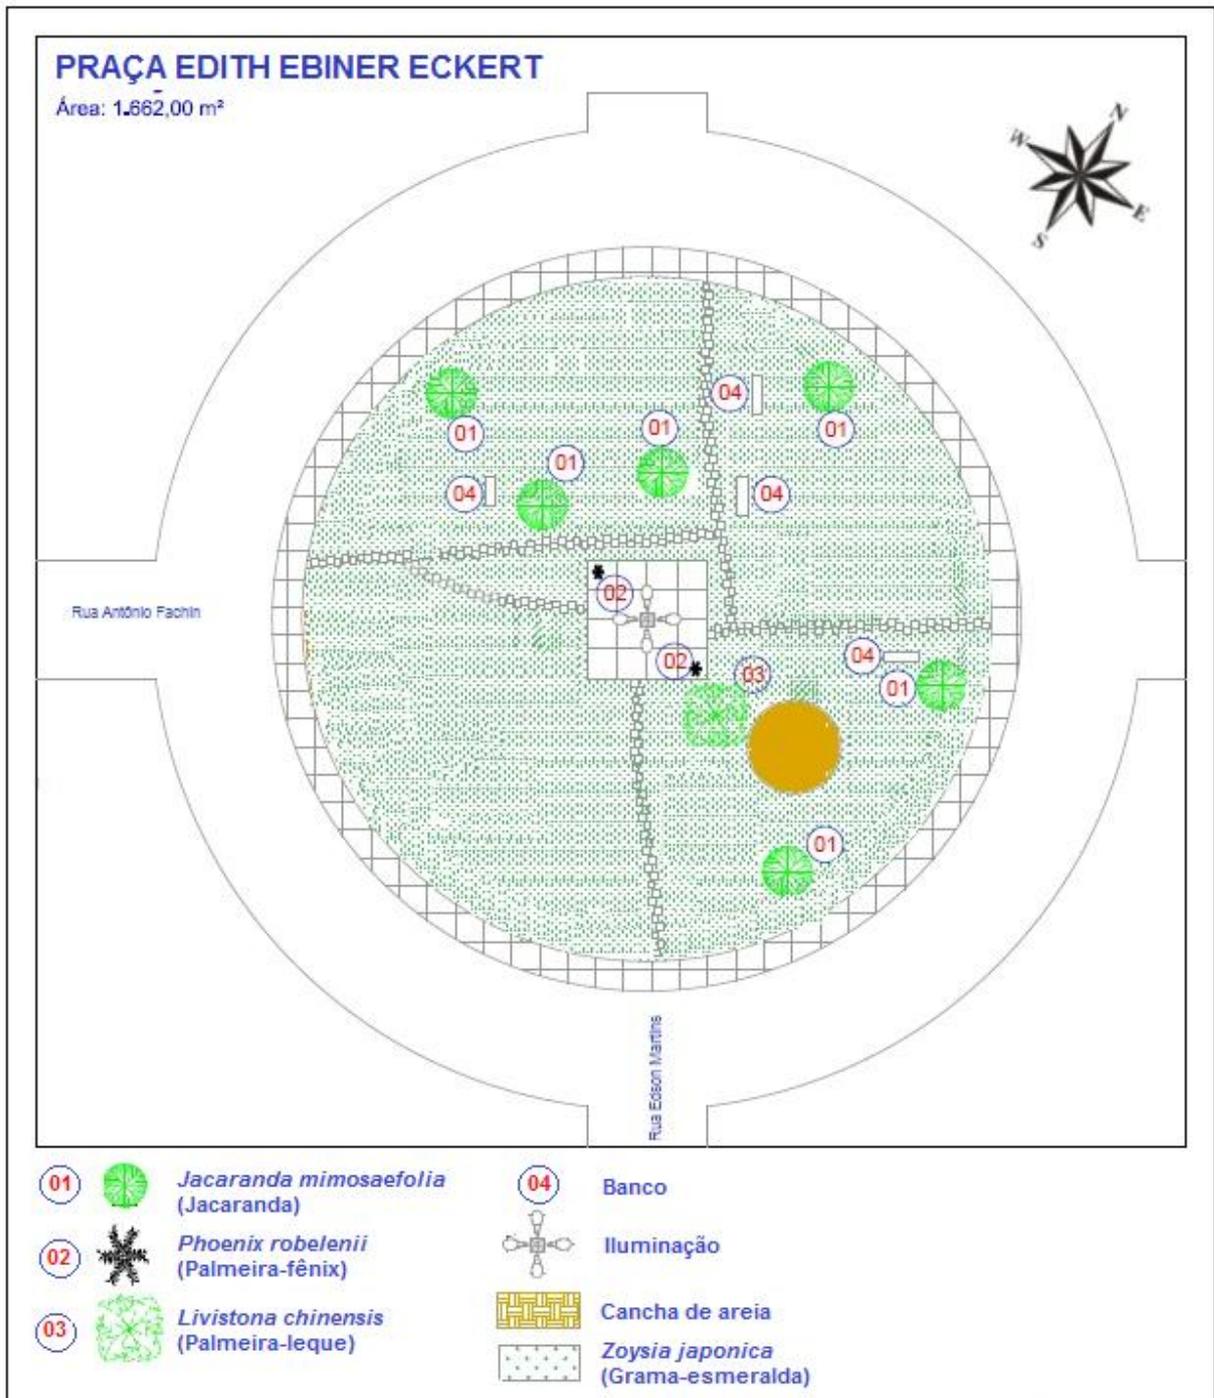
Croqui da Praça Edith Ebner Eckert
